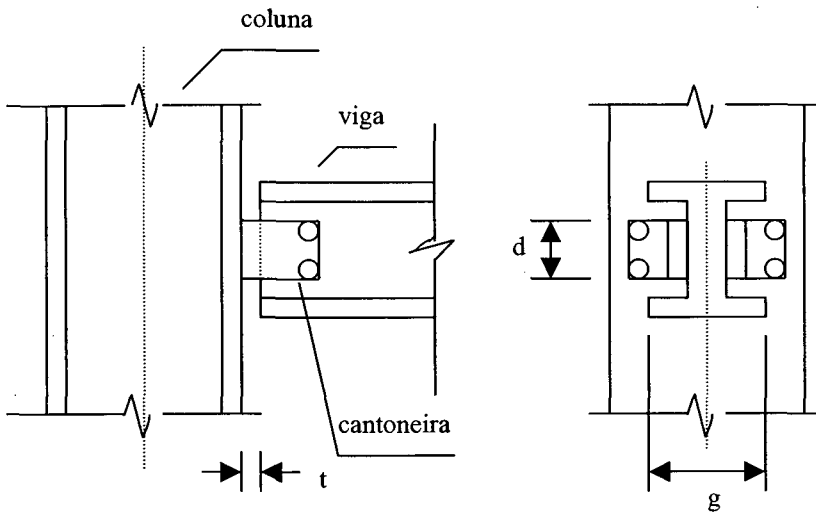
Típica conexão viga-pilar metálica “double web angle”.
